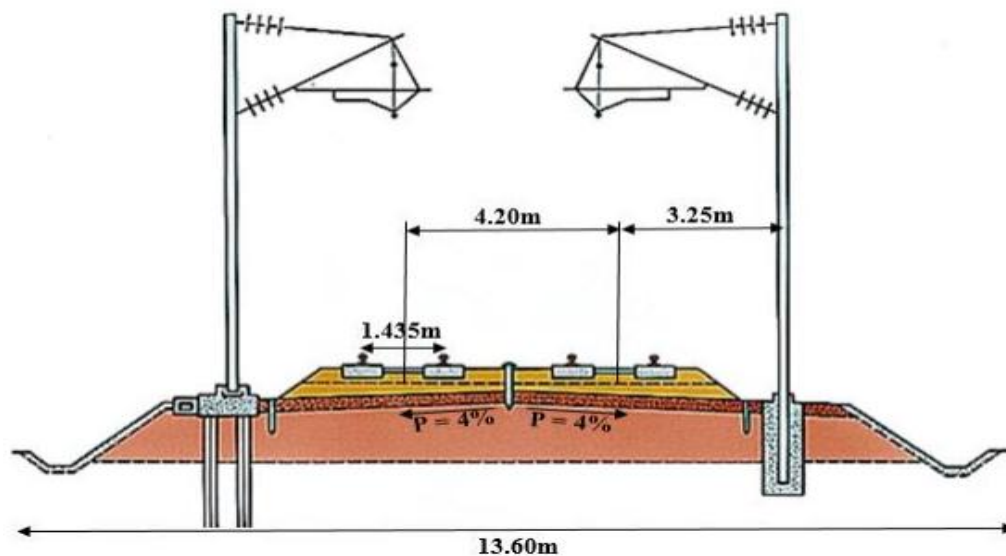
Profil en travers type de la voie ferrée à double voies.
